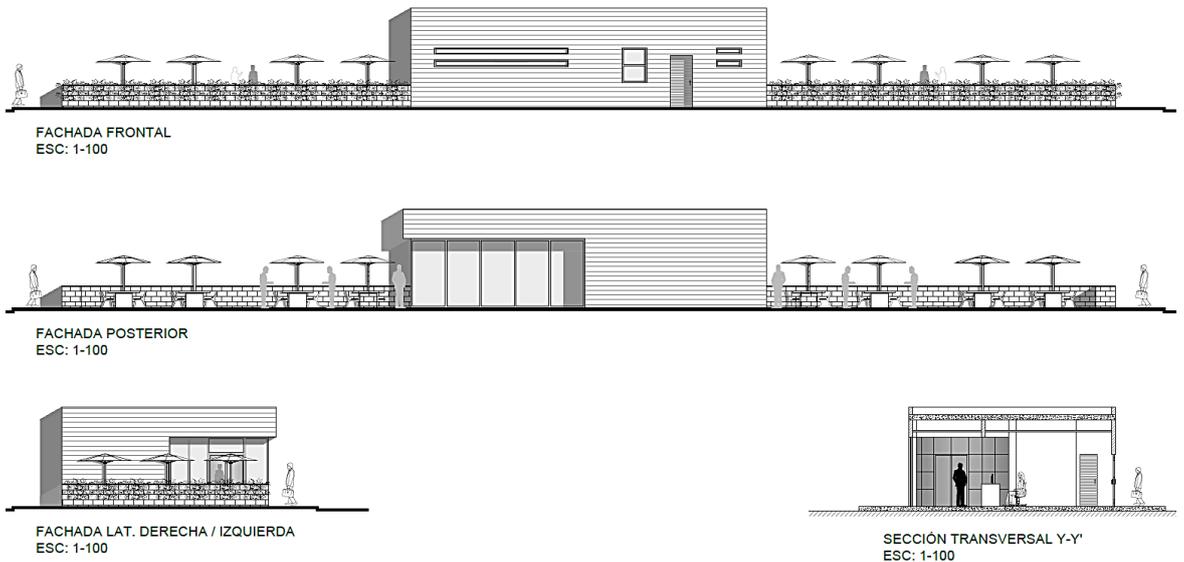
Planos arquitectónicos de restorán - paddock
